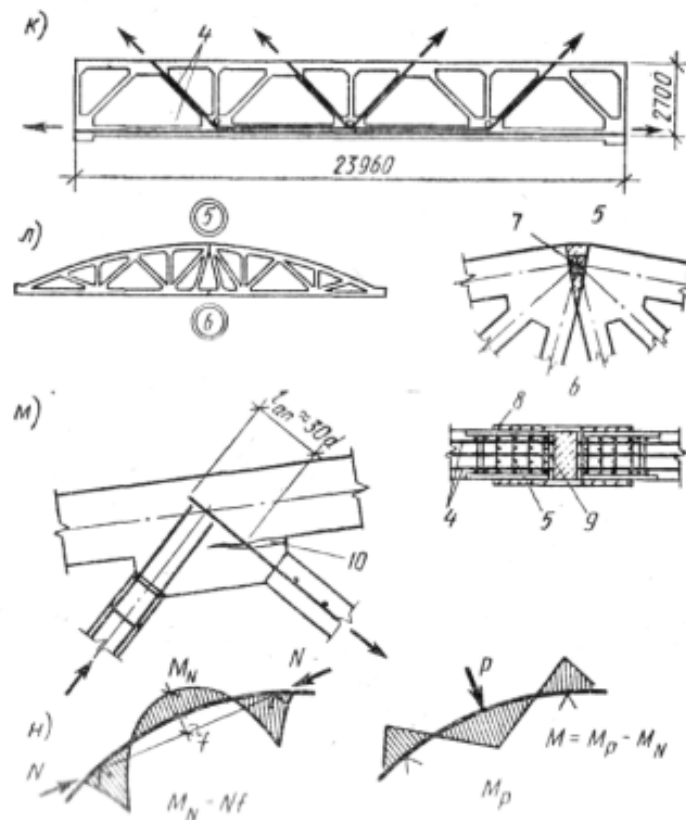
продолжение . Конструкция железобетонных стропильных ферм:
